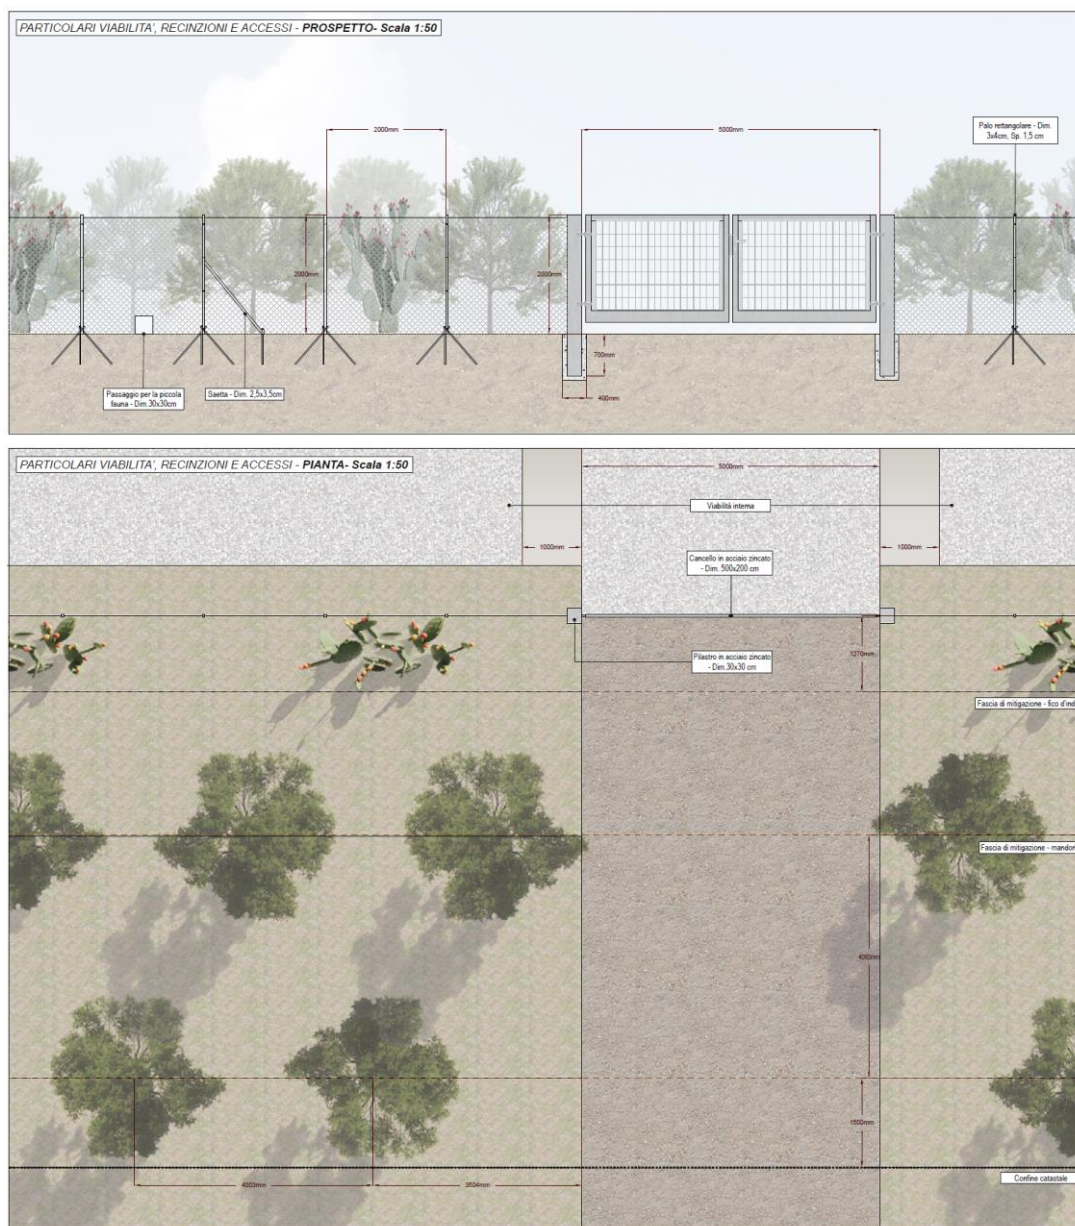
Area di mitigazione di tipo A, in sezione trasversale e in pianta
